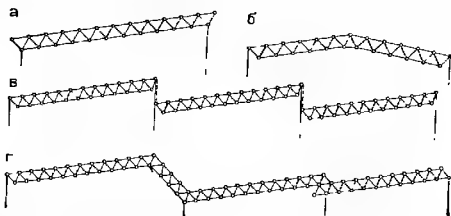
Варианты использования перекрестно-стержневых конструкций в покрытиях с поперечным сечением различного профиля
